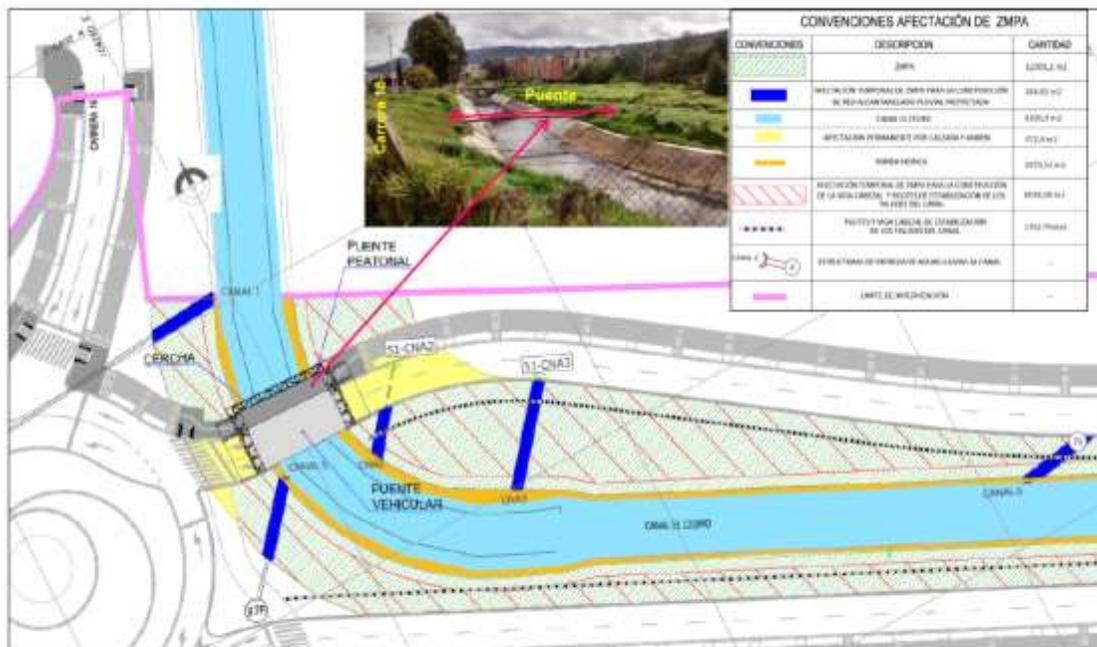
PLANTA PUENTE VEHICULAR, PEATONAL Y CERCHA CARRERA 15 – PILOTES – ALCANTARILLADO PLUVIAL
